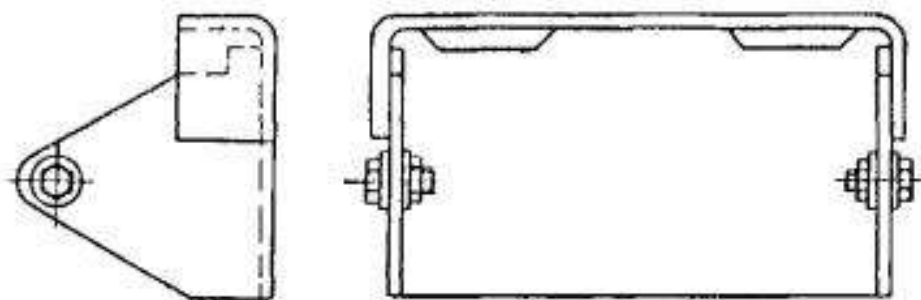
Заглушки торцовые для закрывания металлических коробов
